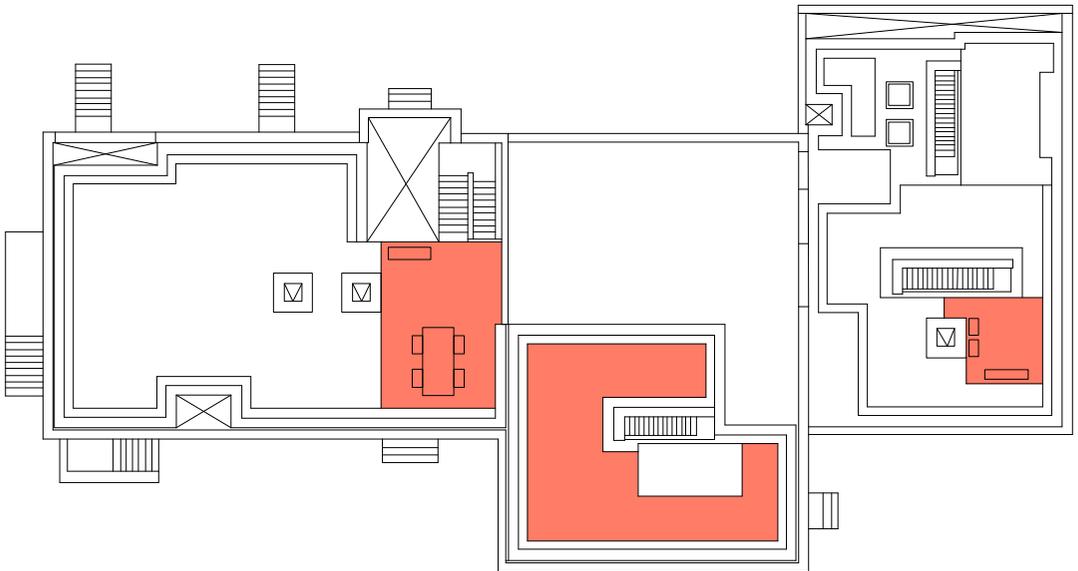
Alte Tabakfabrik, Grundriss DG
